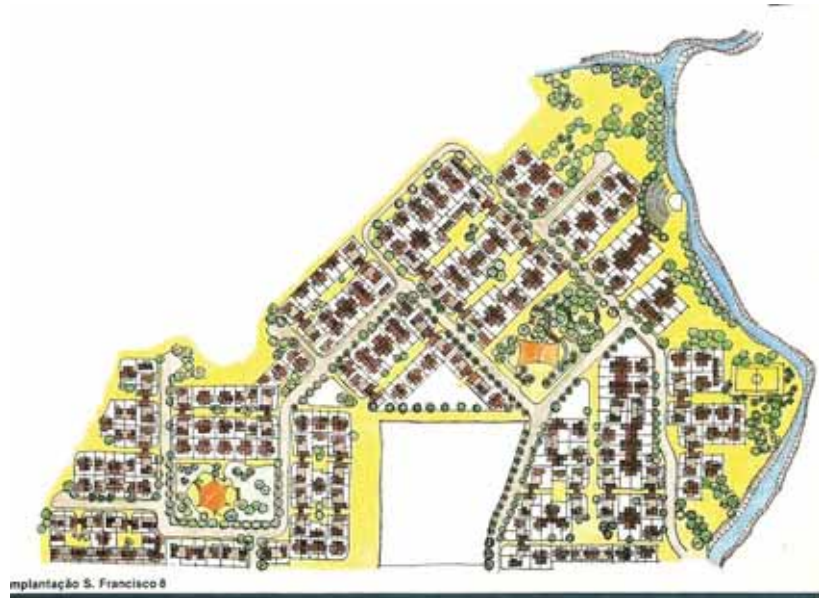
Implantação do Conjunto Habitacional. Fonte: Suplemento especial da revista Projeto.
